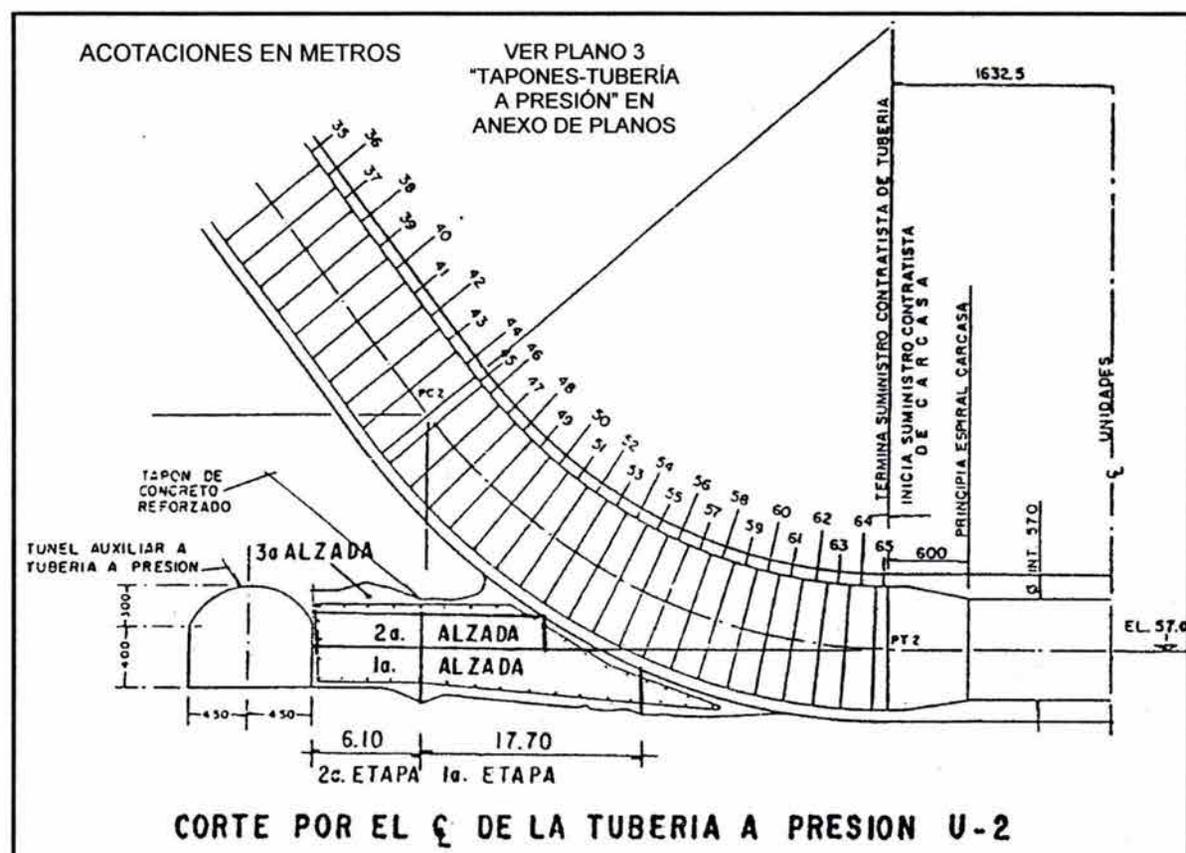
RAMAL INFERIOR, TUBERÍA A PRESIÓN U-2 (Continuación)
